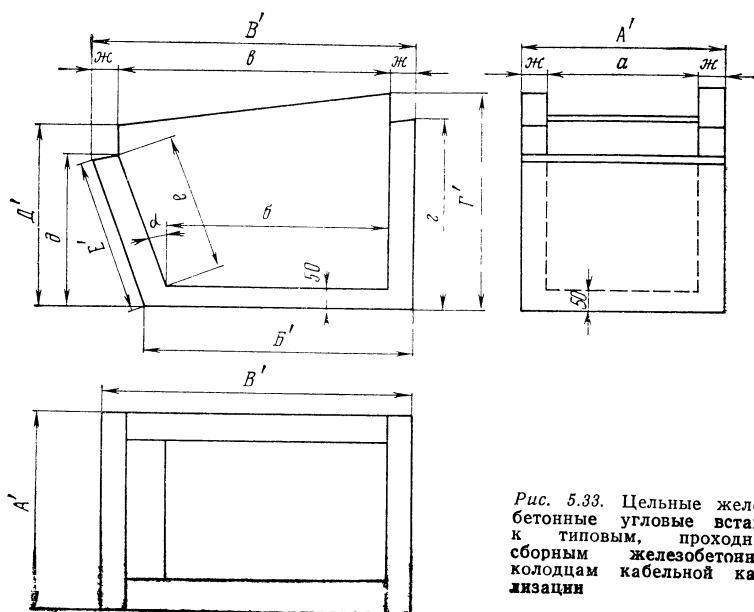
Целые железобетонные угловые вставки к типовым, проходным, сборным железобетонным колодцам кабельной канализации
